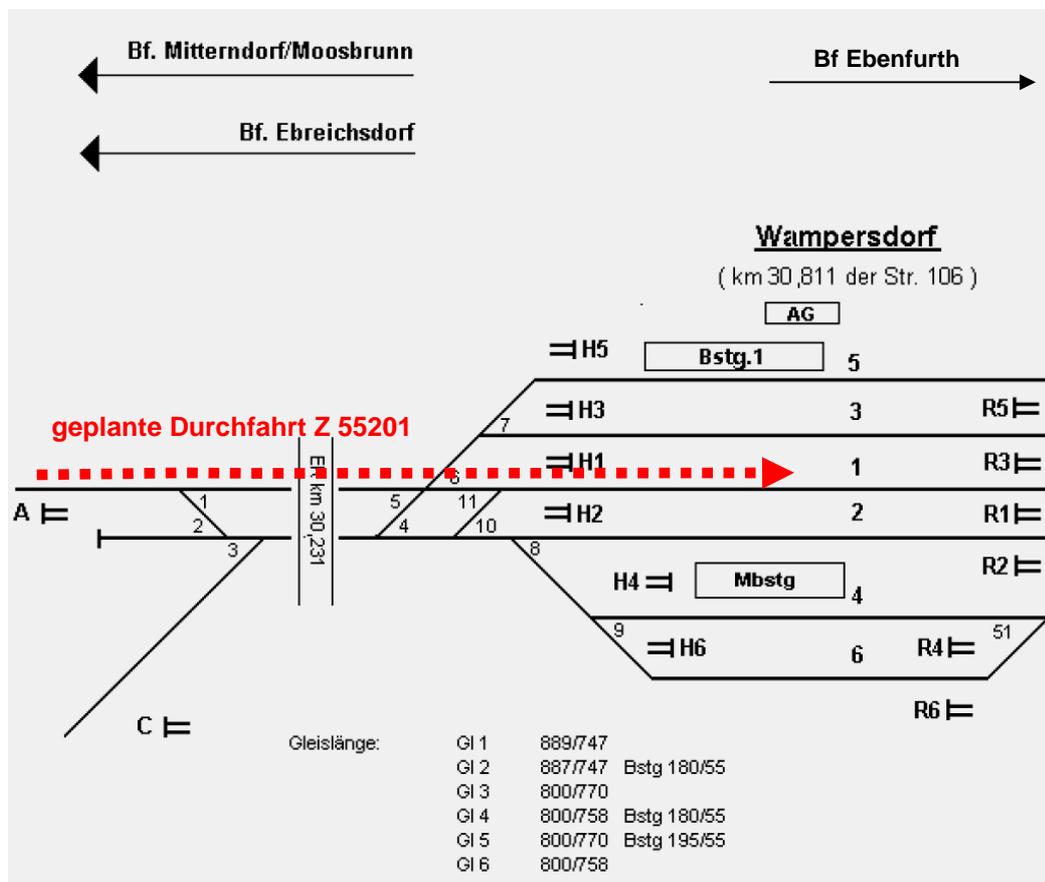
Lageplanskizze Bf Wampersdorf - Quelle IM
